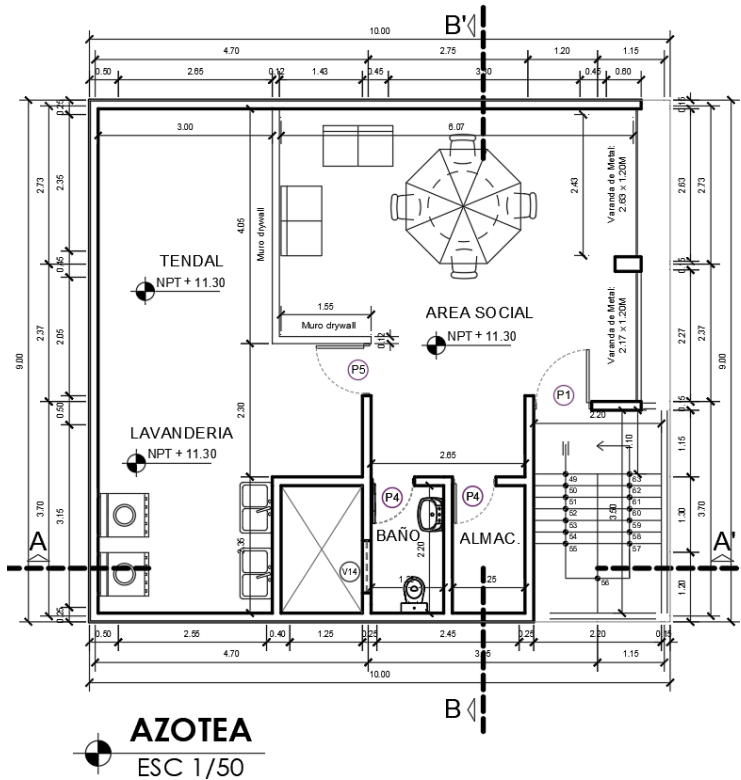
Planta típica del área para vivienda de la azotea. Fuente propia.
